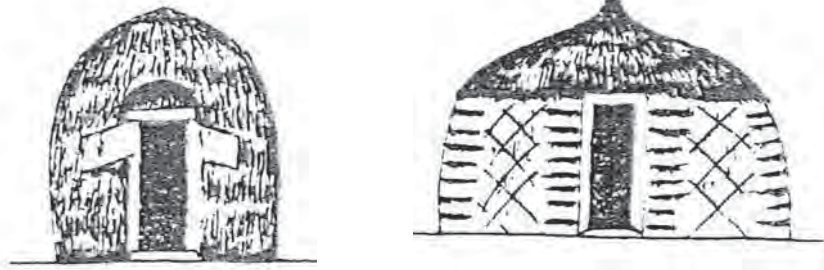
Tipología de cabañas africanas. Construcciones aisladas con planta cuadrada.
